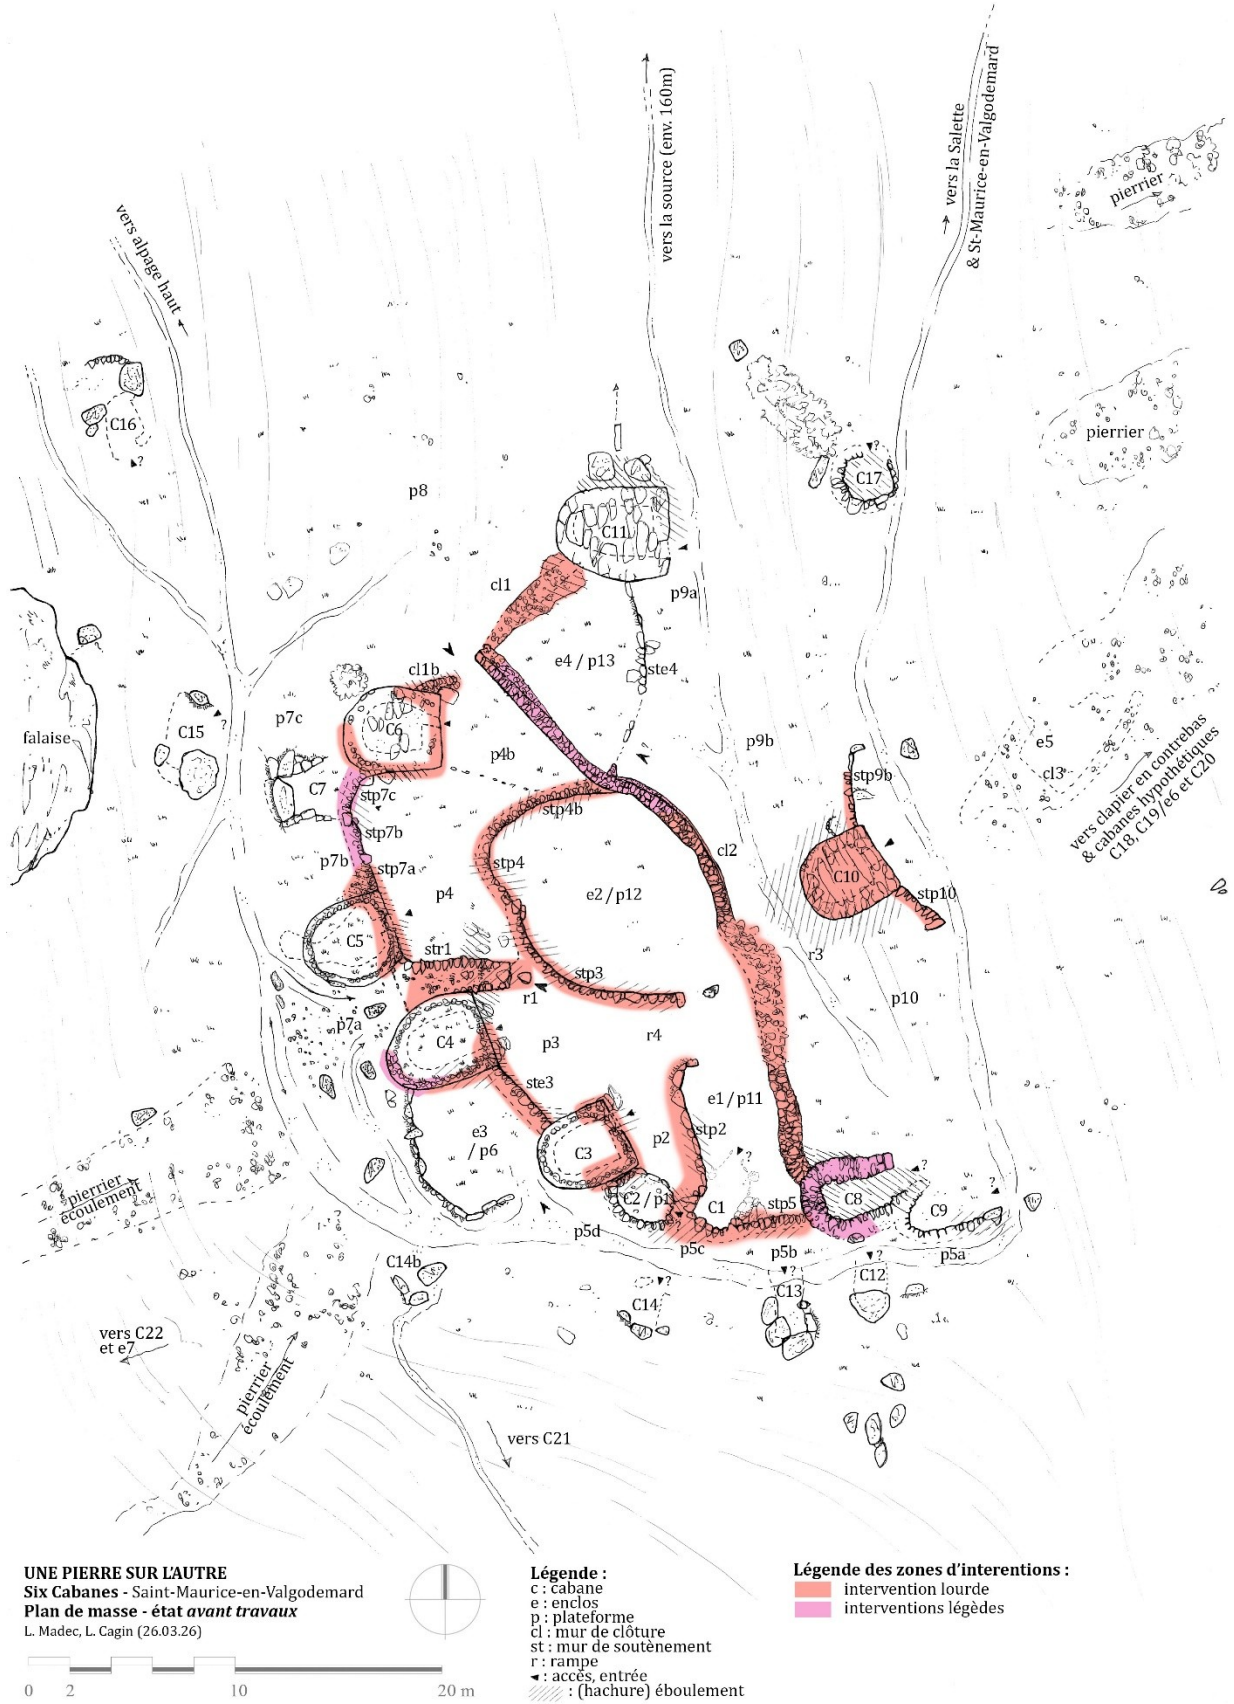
Zonage des travaux sur le plan de masse du site - avant travaux.
